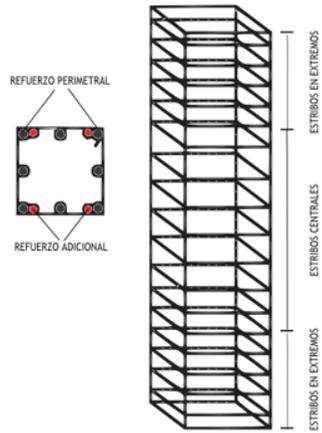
Ejemplo de Armadura para columnas de hormigón armado.
